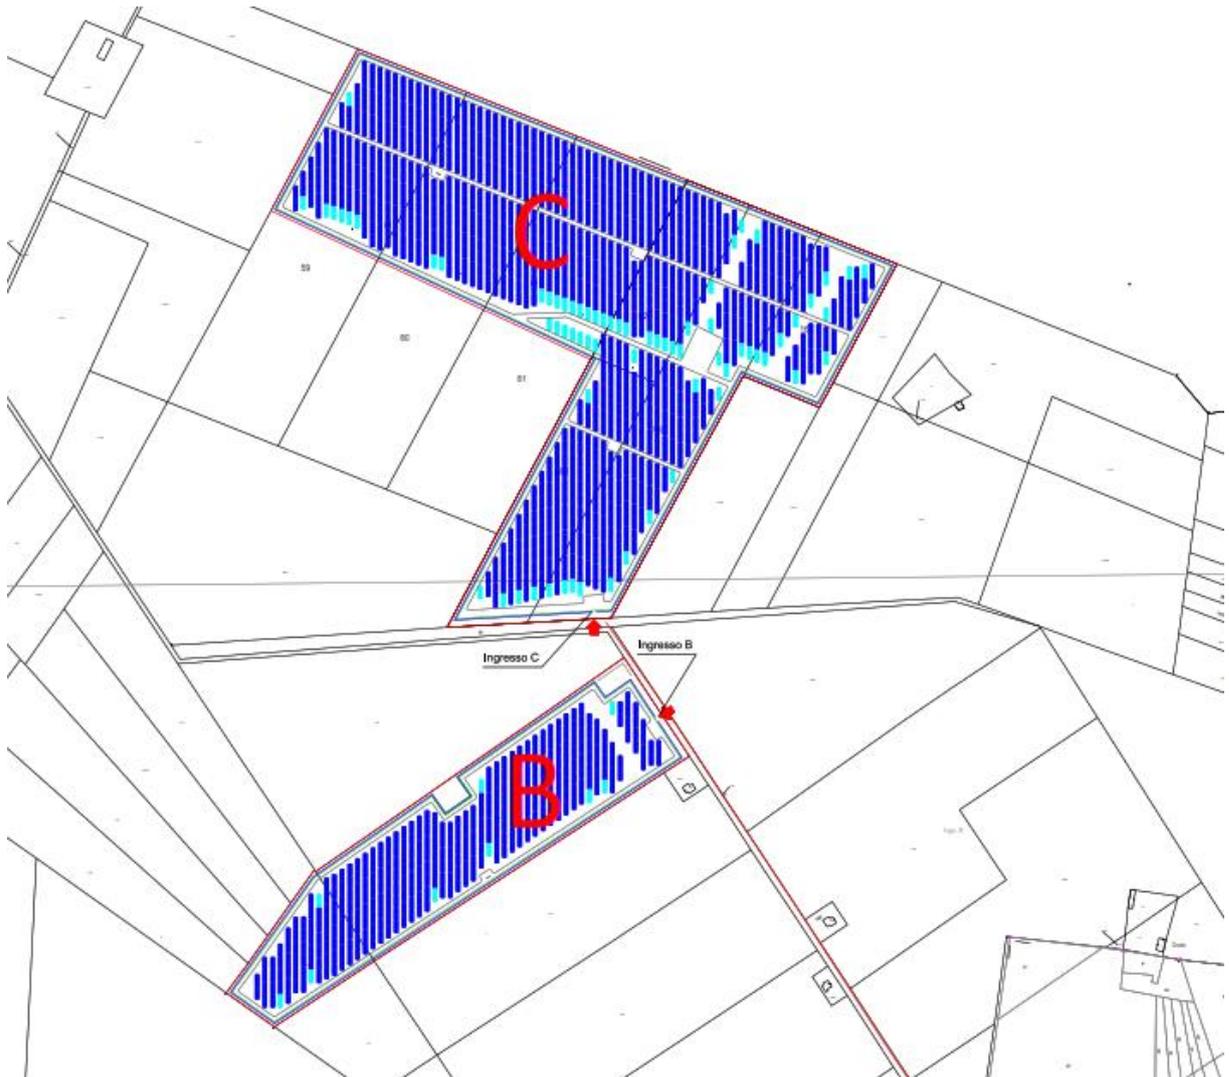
Blocco "B" e "C" su planimetria catastale
